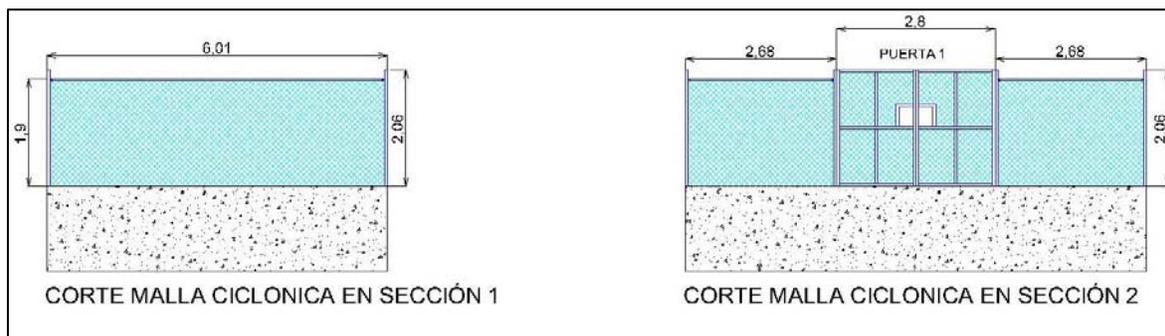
Plano de Malla Ciclónica propuesta para división de áreas (Parte I)
